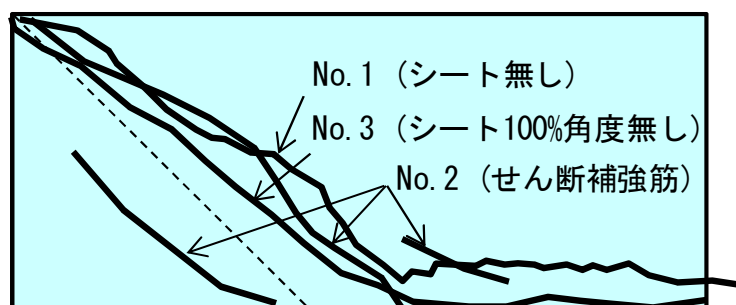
せん断ひび割れ位置 (試験番号 1～3)
